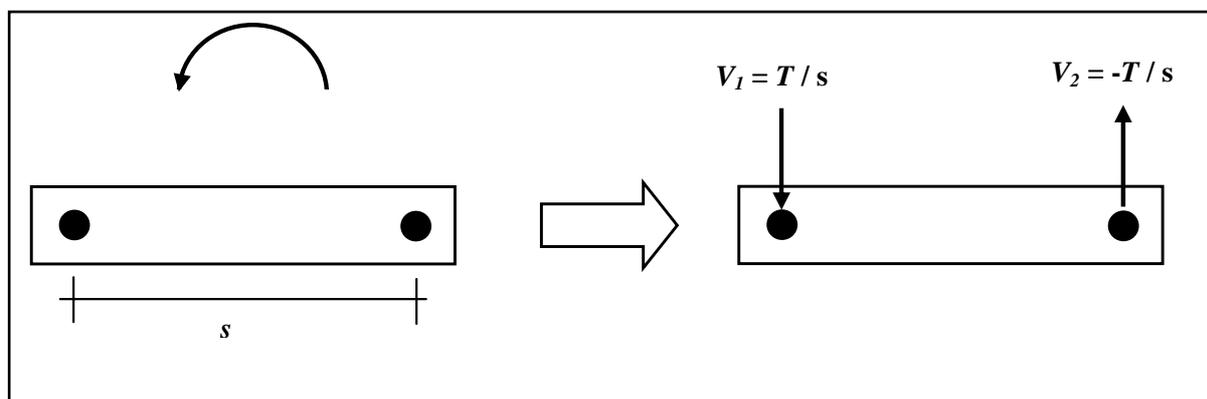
Gruppe von Dübeln unter Torsionsmoment; Querlasten, die auf die einzelnen Dübel der Gruppe wirken, ändern ihre Richtungen
